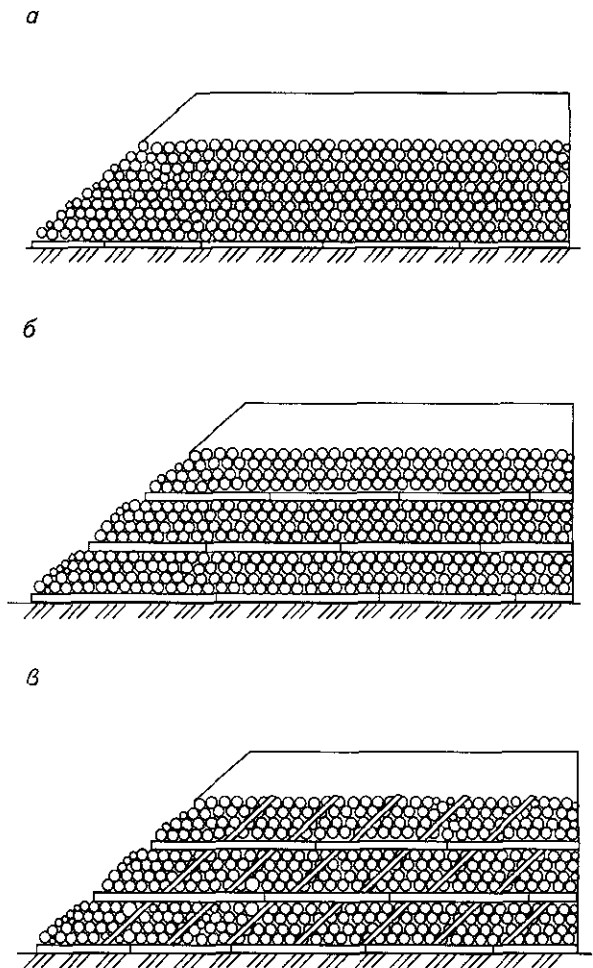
Типы штабелей для хранения круглых лесоматериалов:
